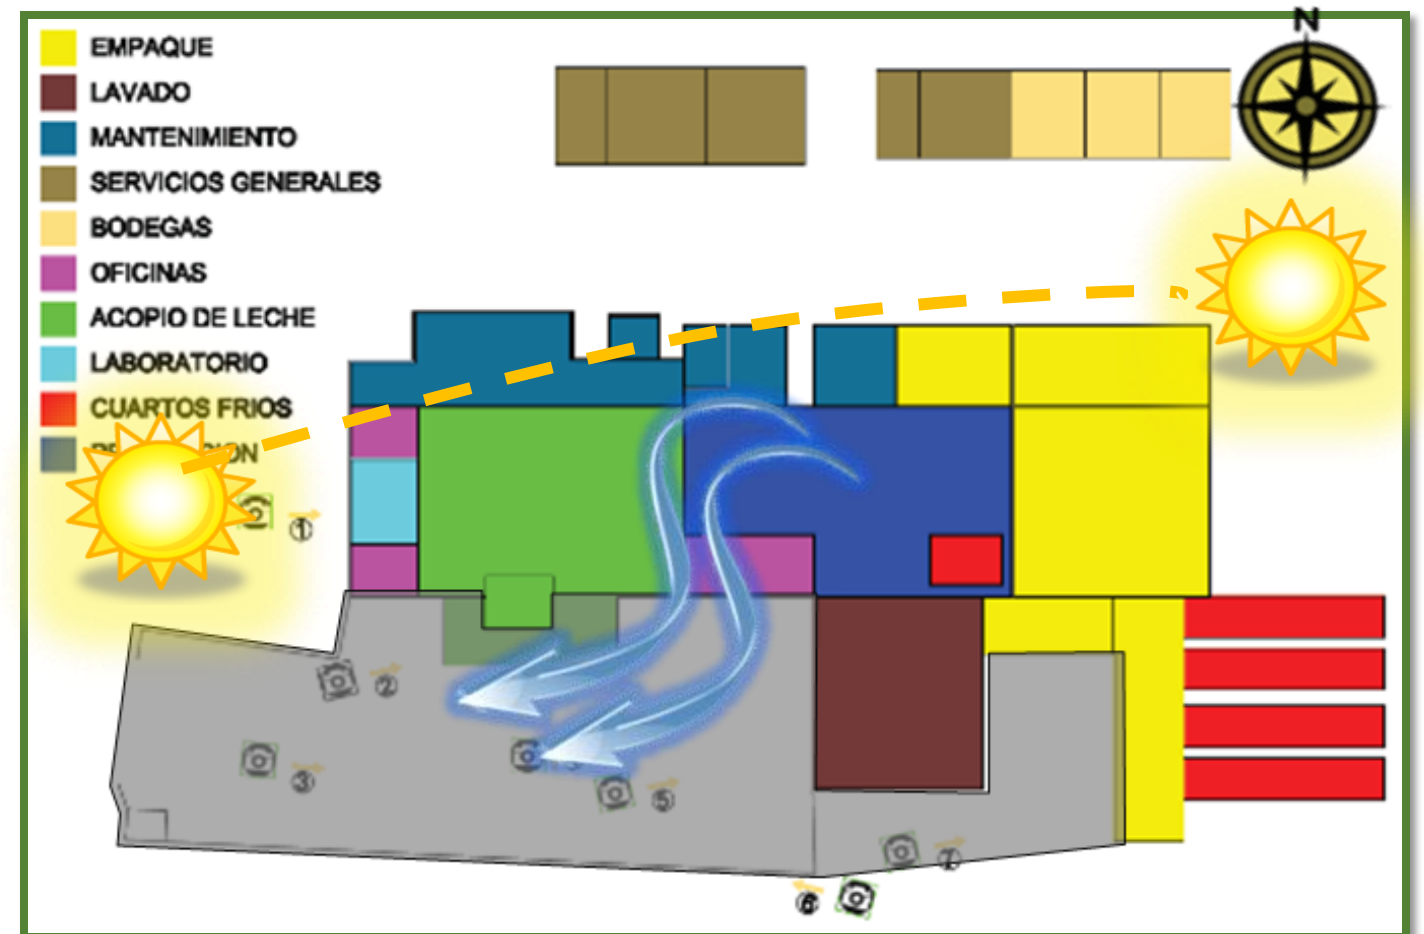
Plano de vientos, soleamientos y zonas elaborado en base a la primera visita a la planta de producción de leche. El edificio de producción es asimétrico en planta, debido a que existe sustracción de elementos en una de las fachadas del mismo, esas sustracciones se realizaron debido a que es el área de mantenimiento, y esa área debe estar al aire libre por las calderas y plantas eléctricas. En otra de las fachadas se muestra lo que son inserciones, estas se realizaron debido a la falta de espacios que no se consideraron a la hora de la construcción del mismo. Esta área es abierta ya que es el lavado de cantaros de aluminio. En la imagen 32 se muestra el análisis en planta de esta industria.
